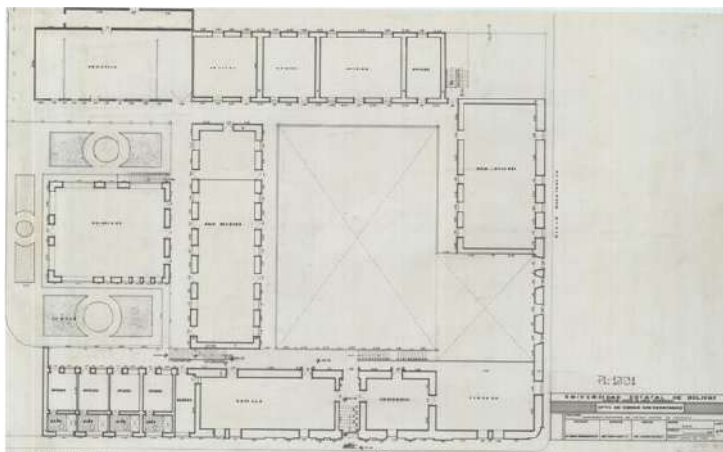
Plano Arquitectónico, Bloques Oeste Antiguo Hospital Corazón de Jesús del Cantón de Guaranda, Provincia Bolívar / Repositorio INPC.
